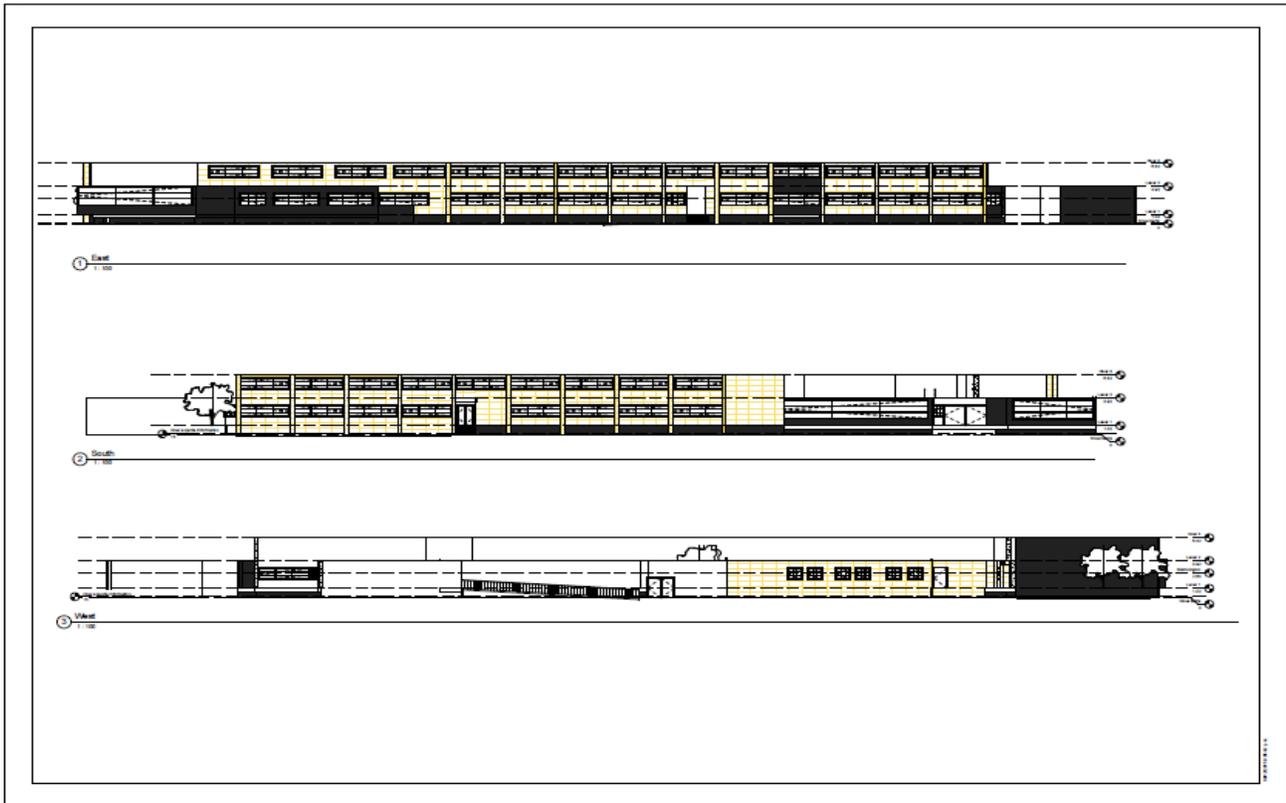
GENERACION DE FACHADAS EN REVIT 3D
